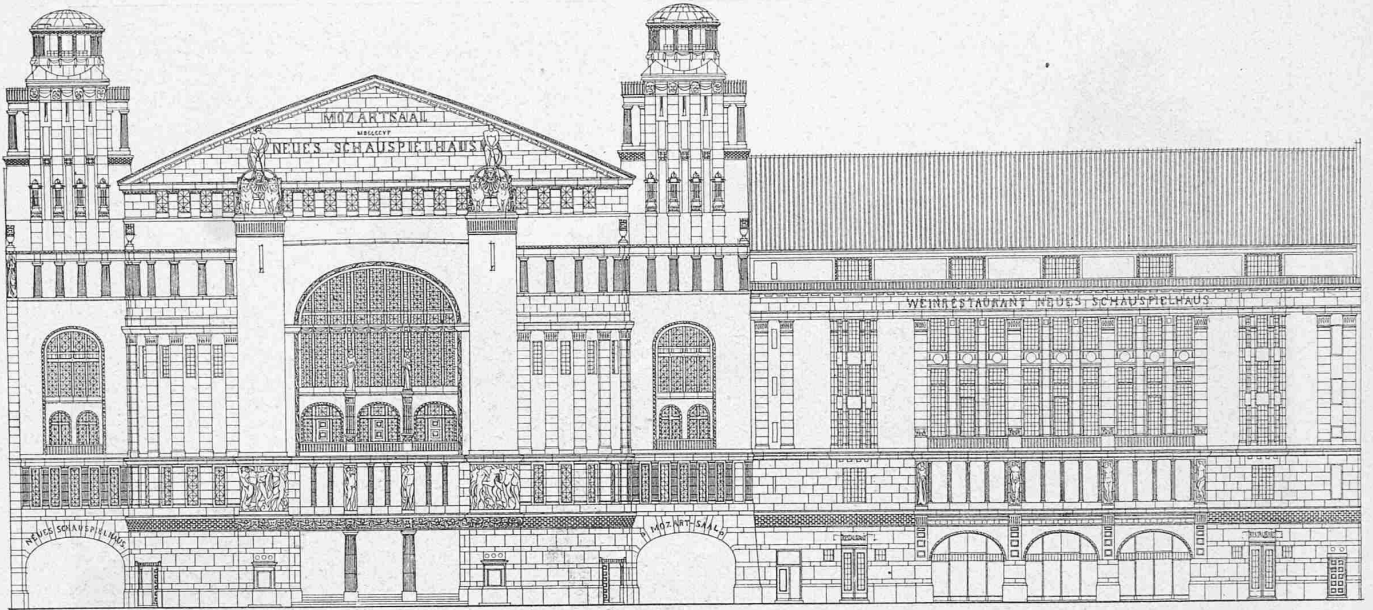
Fassaden des Schauspielhauses am Nollendorfplatz und des Restaurationsgebäudes an der Motzstrasse.
